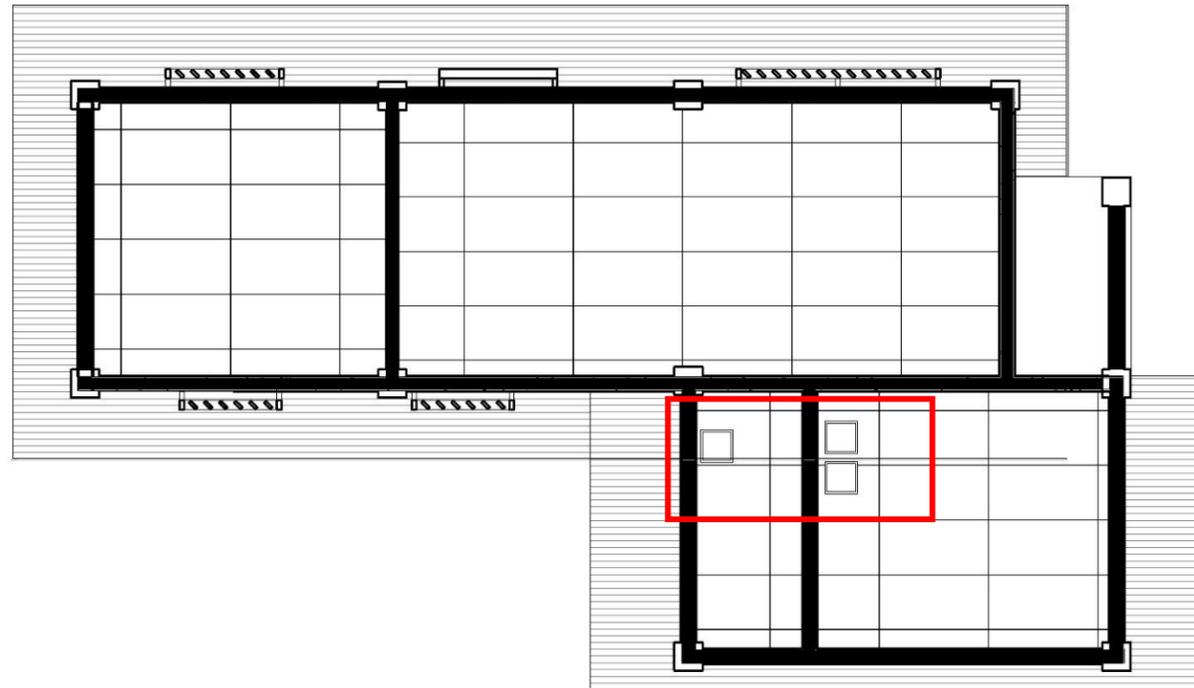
Planta de cielo raso de vivienda H-4. Elaborado por autoras.
